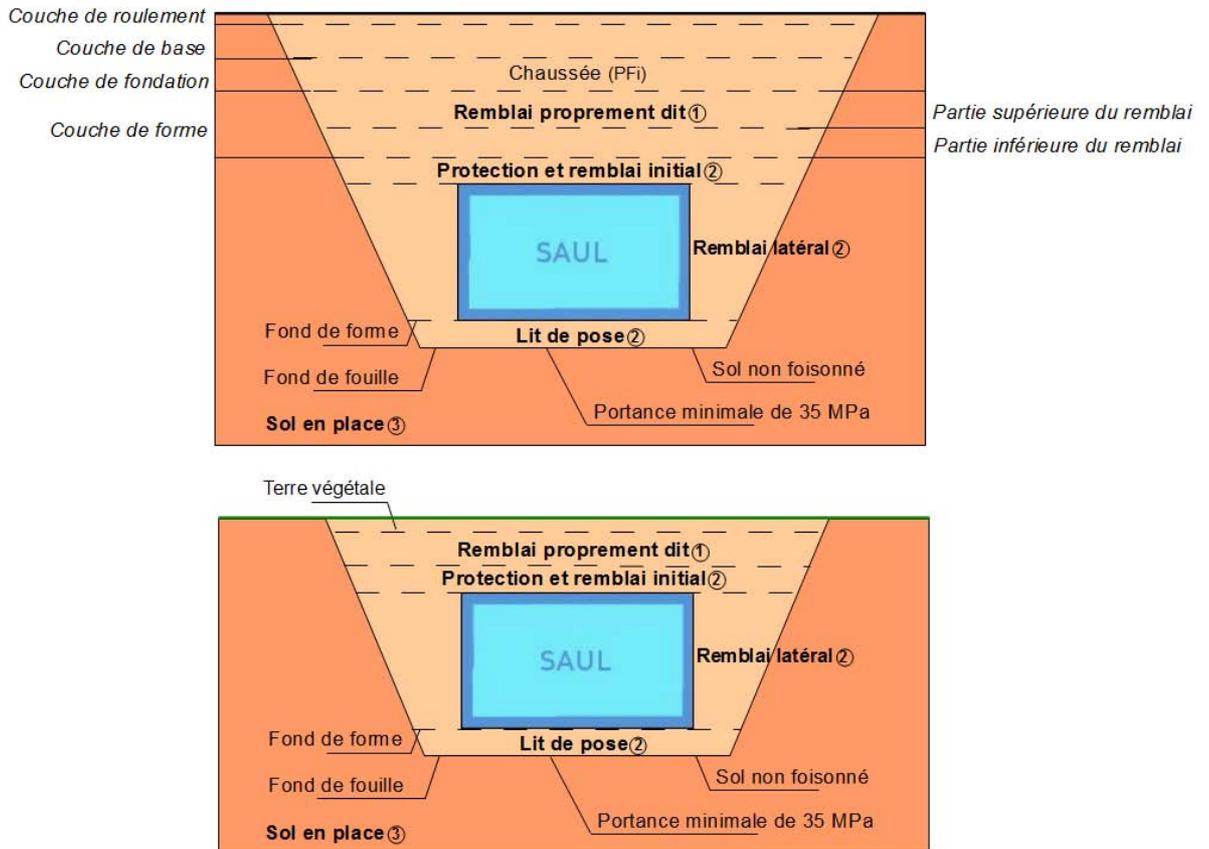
Profils-types d'ouvrages sous chaussée et sous espace vert
